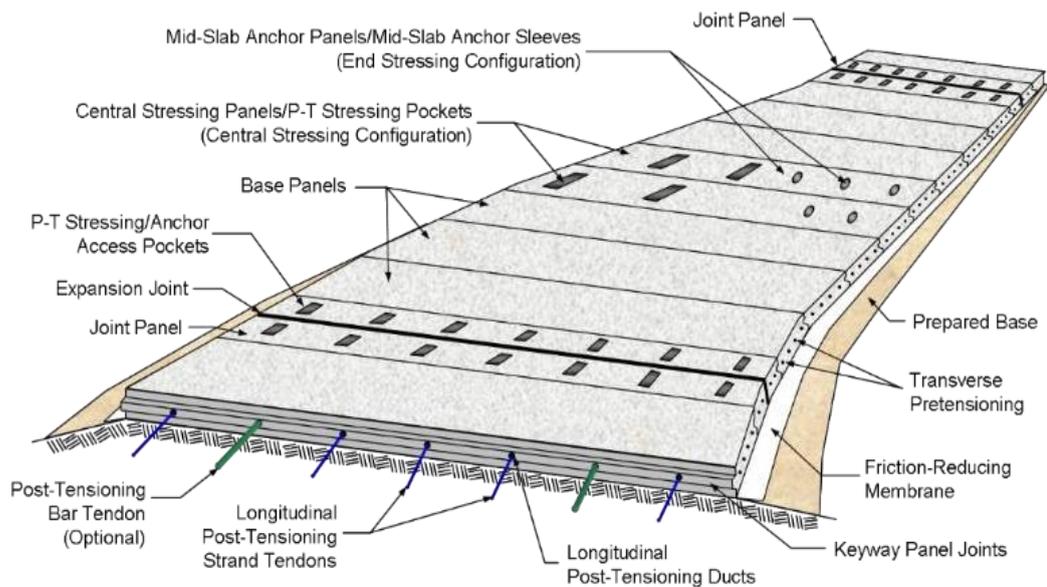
<https://www.thetranstecgroup.com/precast-pavement/precast-concrete-pavement-systems/>
